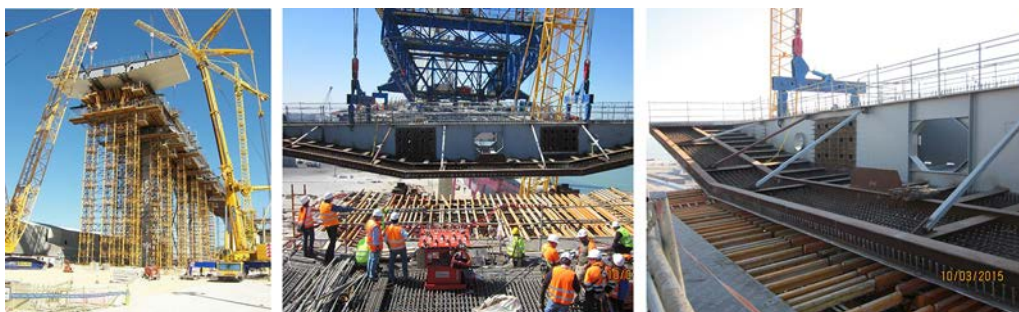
Dovela de conexión sobre cimbra, izado de la misma y colocación sobre el encofrado del tramo de hormigón.
